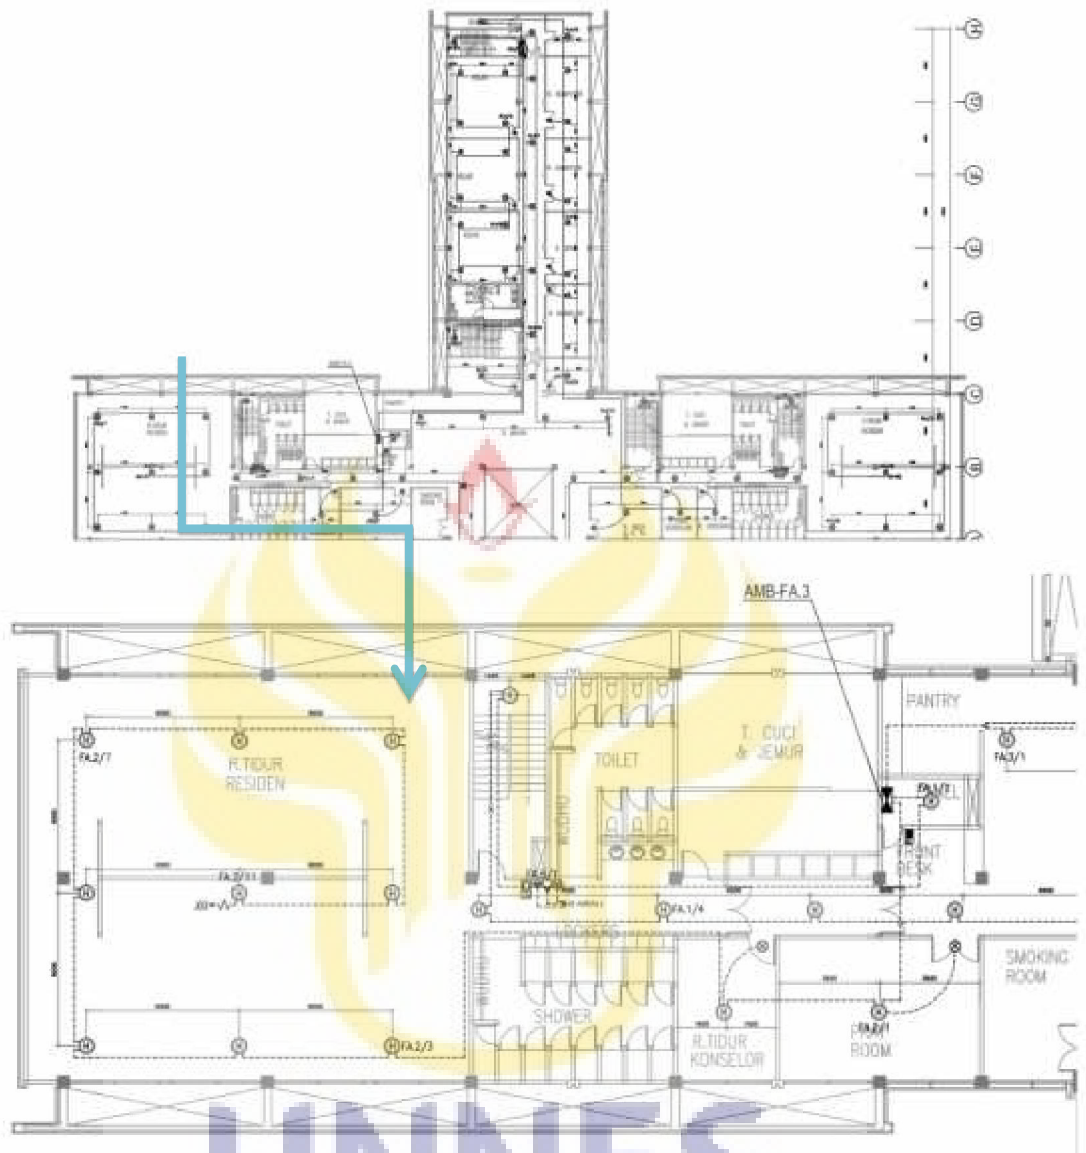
Denah Gedung Primary House/ Asramalt.01
